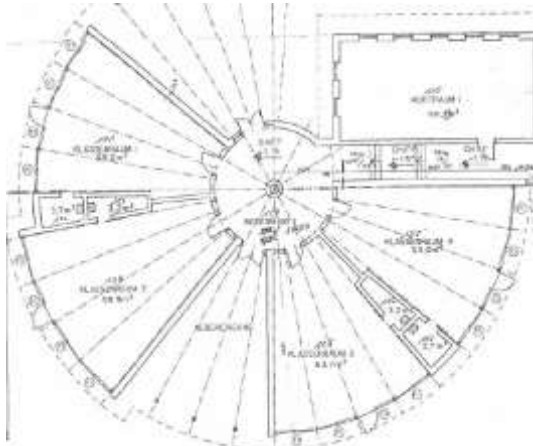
Grundriss Grundschule Dingelstädt.
